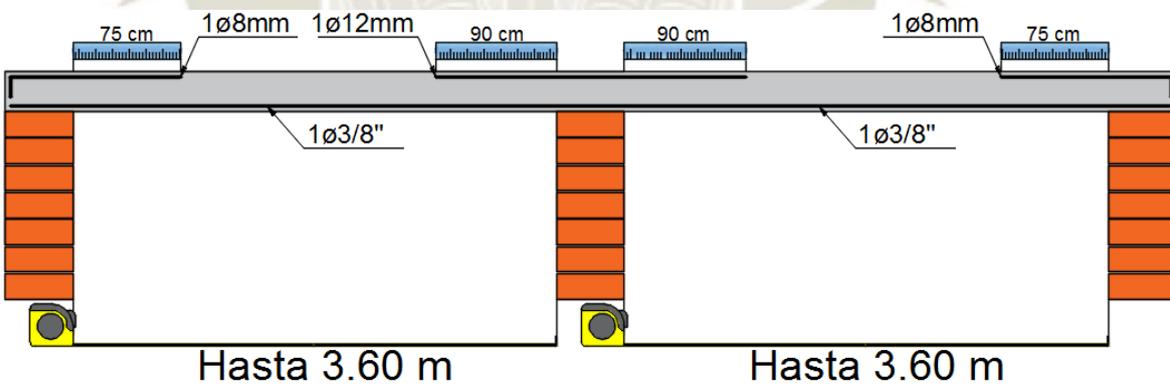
Refuerzo de vigueta hasta 3.6 m por tramo.
